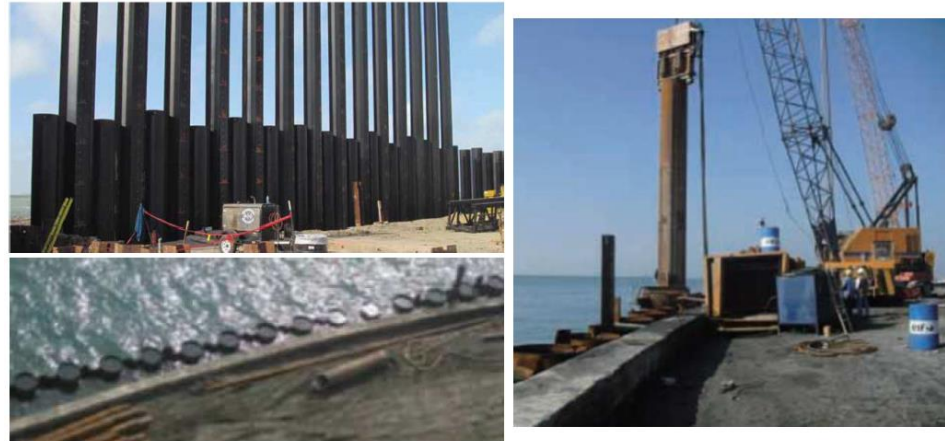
Exemple de chantier de type combiwall (pieux + palplanches)
